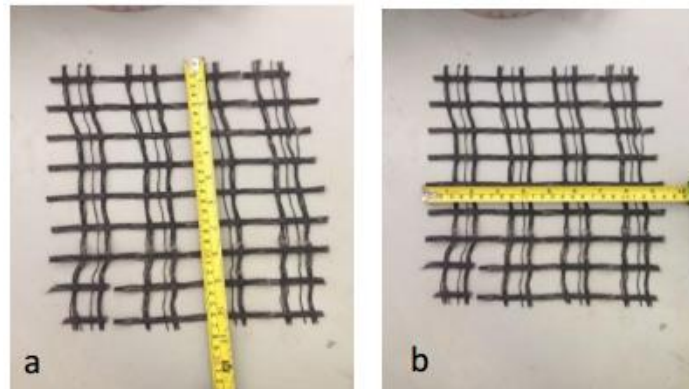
Corte do geossintético: a) Corte transversal da malha, b) Corte longitudinal da malha
